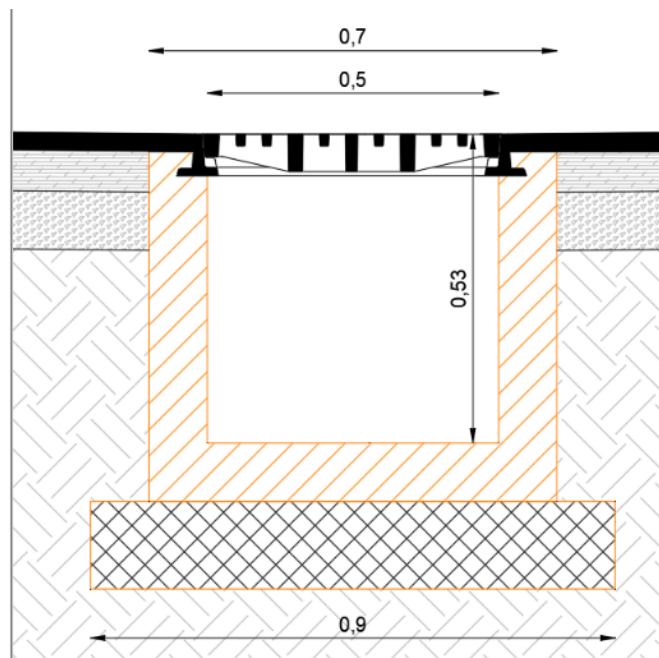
Sezione trasversale della griglia e della condotta trasversale alla strada.
